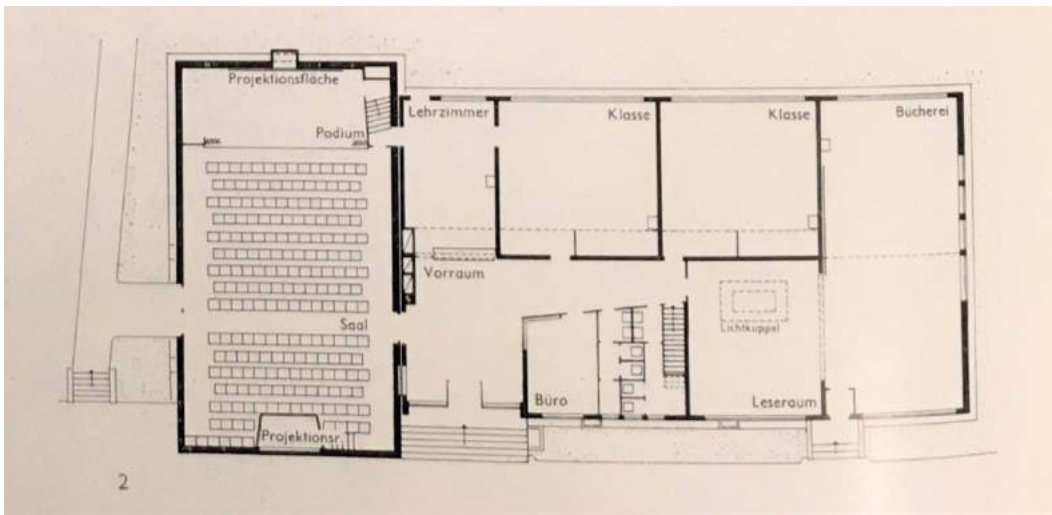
Grundriss des Volksheims Döbling, o.J.
